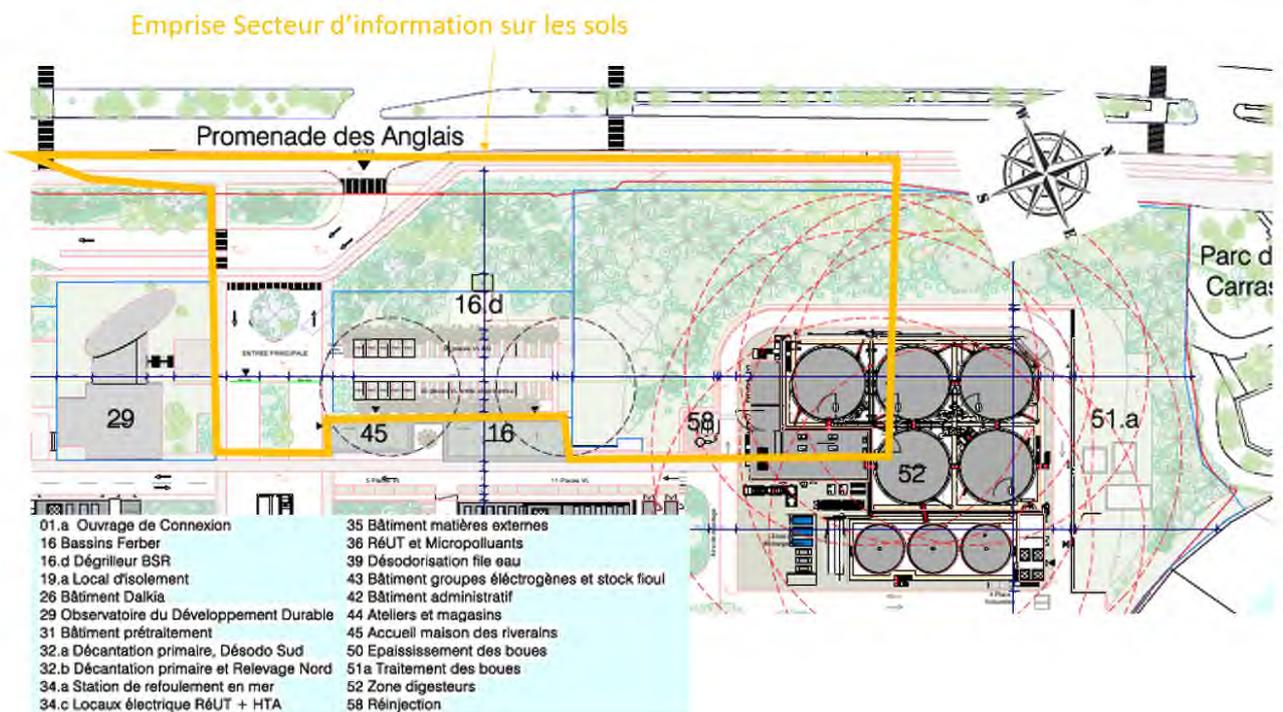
Emprise du SIS sur fond de plan de masse de la demande de permis de construire)
